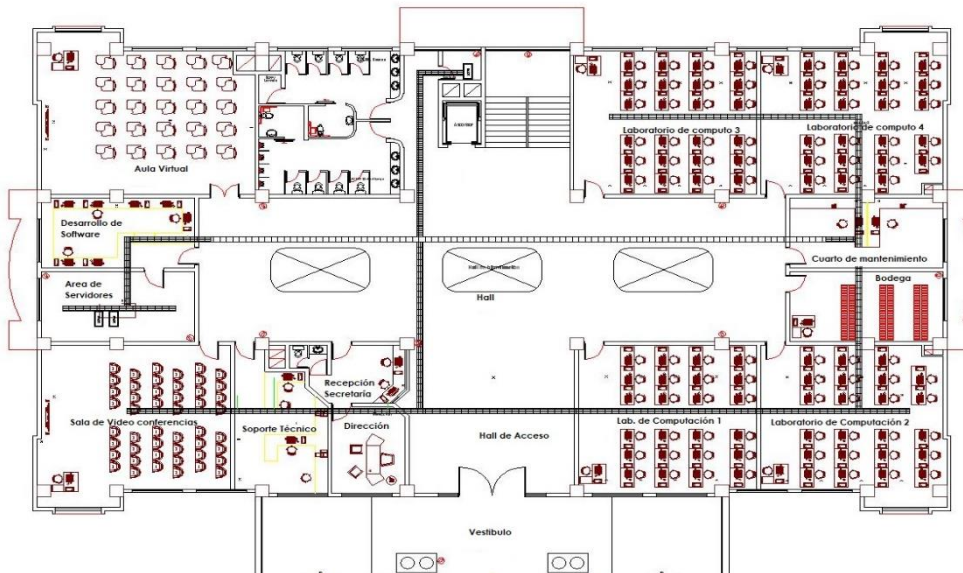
Planos de Infraestructura Planta baja Edificio Postgrado
